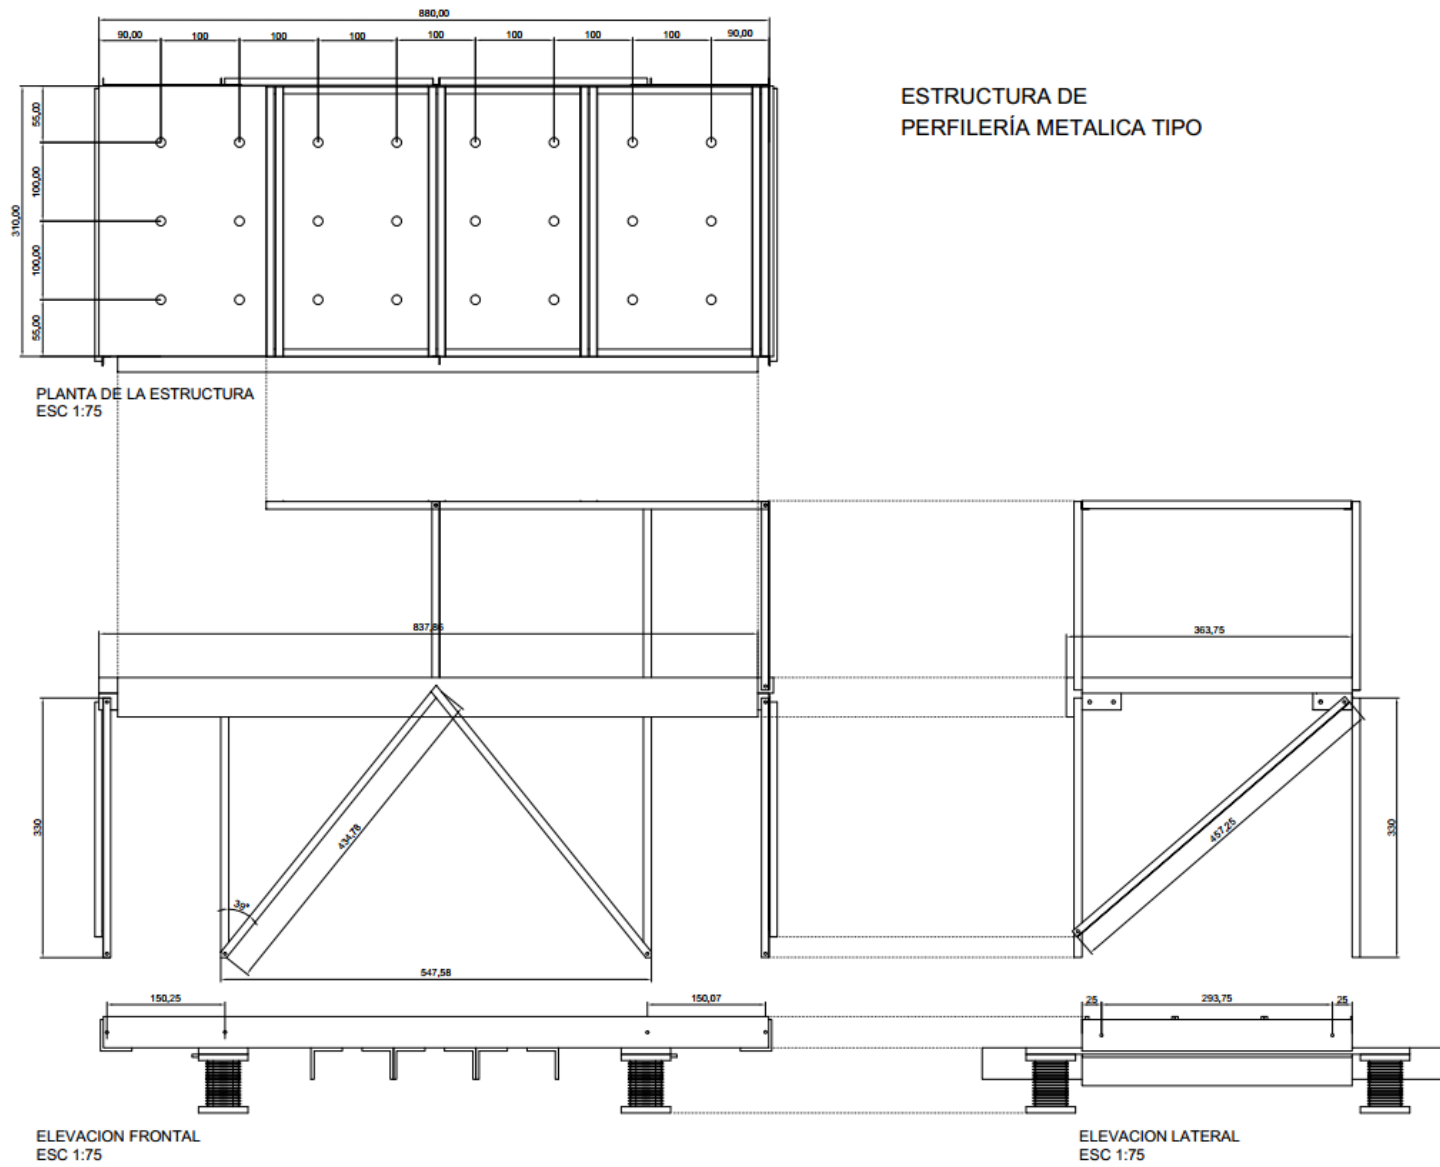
Planos de diseño para estructura de perfilería metálica con sistema de aislación. Todas las dimensiones están en [mm].
